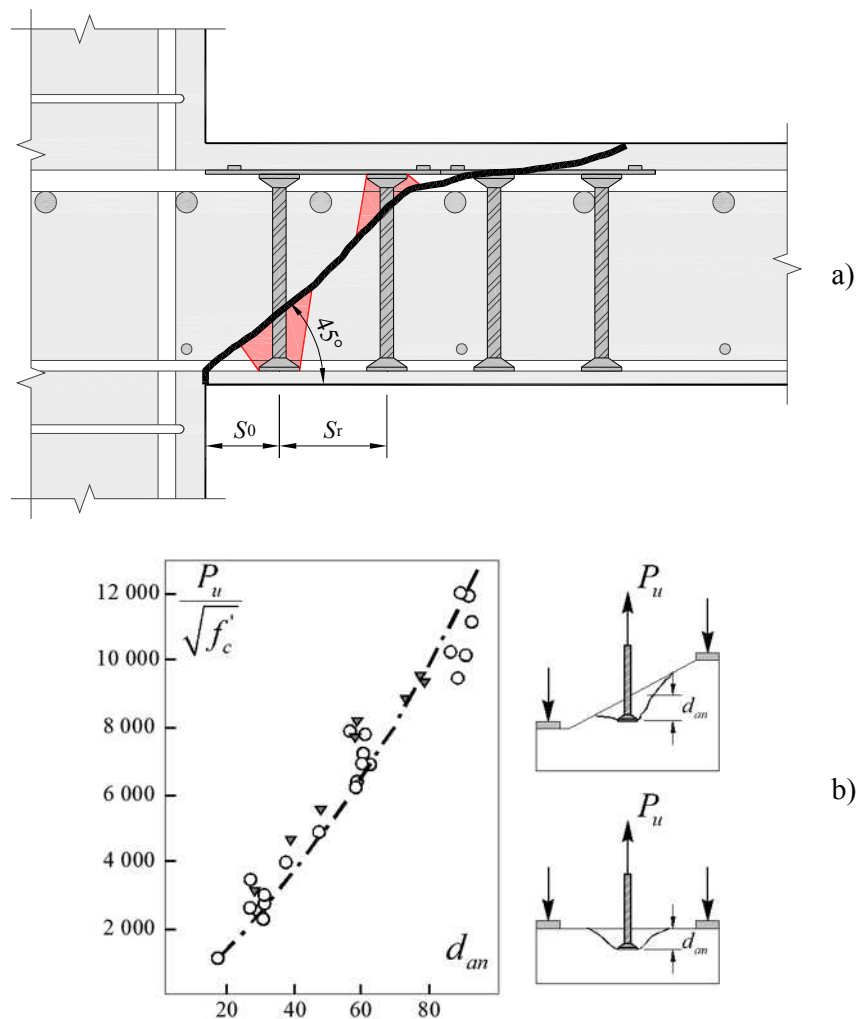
Ancoragem de *double-headed studs* em lajes lisas
